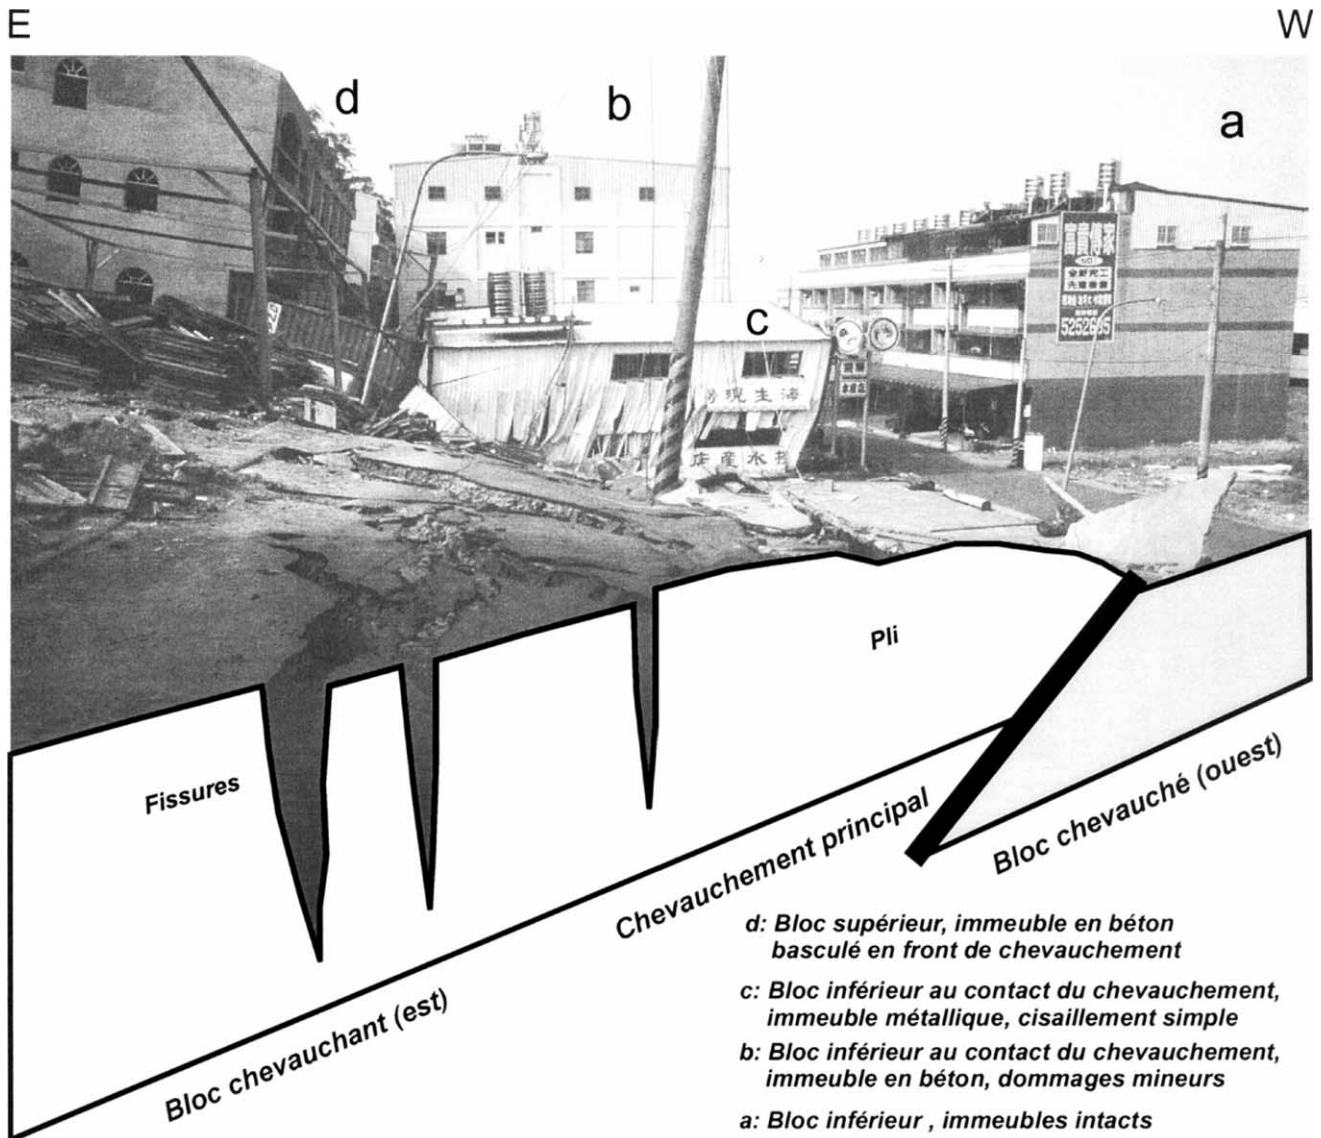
La trace de faille du séisme de Chichi : aspect de la rupture du 21 septembre 1999 dans la ville de Fengyuan (localisation sur la *figure 2c*). La coupe de la structure chevauchante est ajoutée. L'esplanade au premier plan de la photographie était initialement horizontale. Le décalage vertical est de 5–7 m, le compartiment est (à gauche, immeubles d) étant soulevé. Le recouvrement horizontal a une valeur voisine (une large rue séparait les immeubles d et b avant le séisme). La flexure bordière au front du bloc chevauchant est responsable du basculement de l'immeuble de gauche (d), situé sur cette lèvre chevauchante. Noter aussi la fissuration intense (fentes ouvertes) à l'extrados de la flexure frontale du chevauchement. L'immeuble (b), situé sur le compartiment inférieur au contact de la faille, n'est que faiblement endommagé. Les immeubles (a) n'ont pratiquement pas souffert. Une construction métallique (c), dans la même position que (b), a subi un cisaillement simple (sommet vers la droite).
